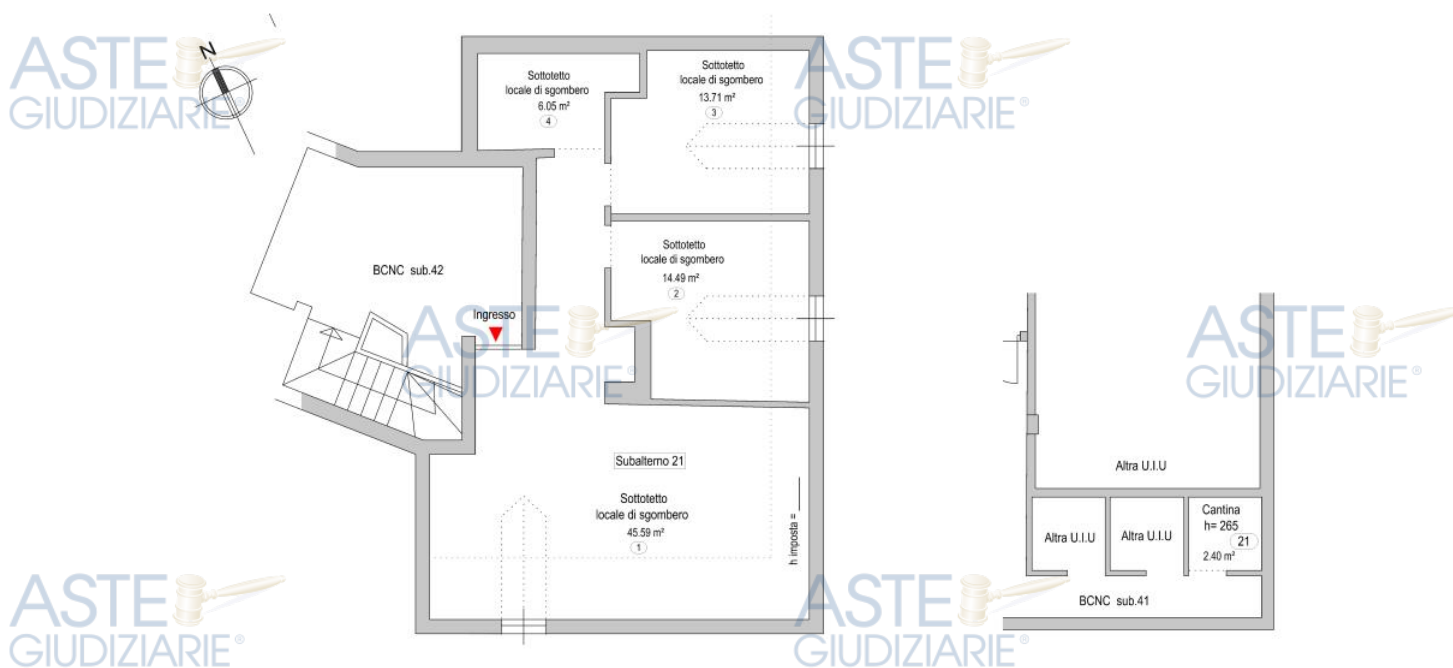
Planimetria subalterno n.21 (piano secondo e piano interrato). Si rimanda all'Allegato A per elaborato in scala
